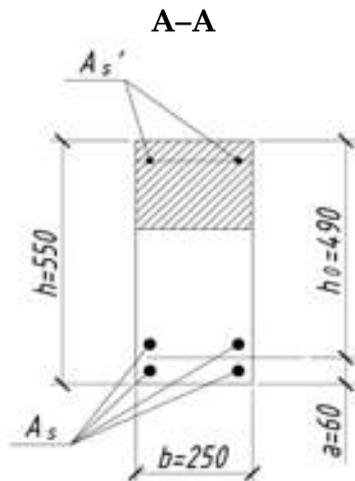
Расположение продольной арматуры железобетонной балки в пролёте: сечение в пролете (А – А);  $h$  – высота сечения;  $h_0$  – рабочая высота сечения;  $b$  – ширина сечения;  $A_s$  – площадь рабочей арматуры
